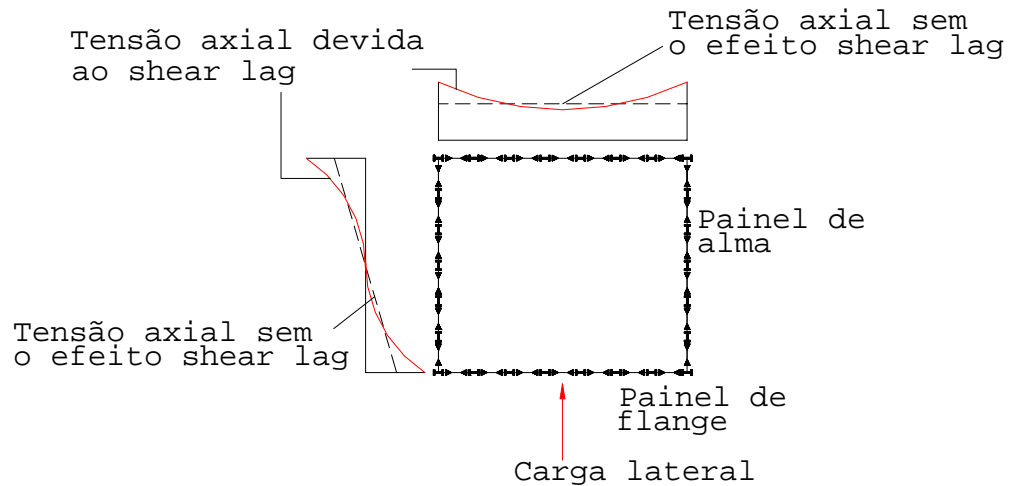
Distribuição de tensões axiais na estrutura tubular aporticada.
